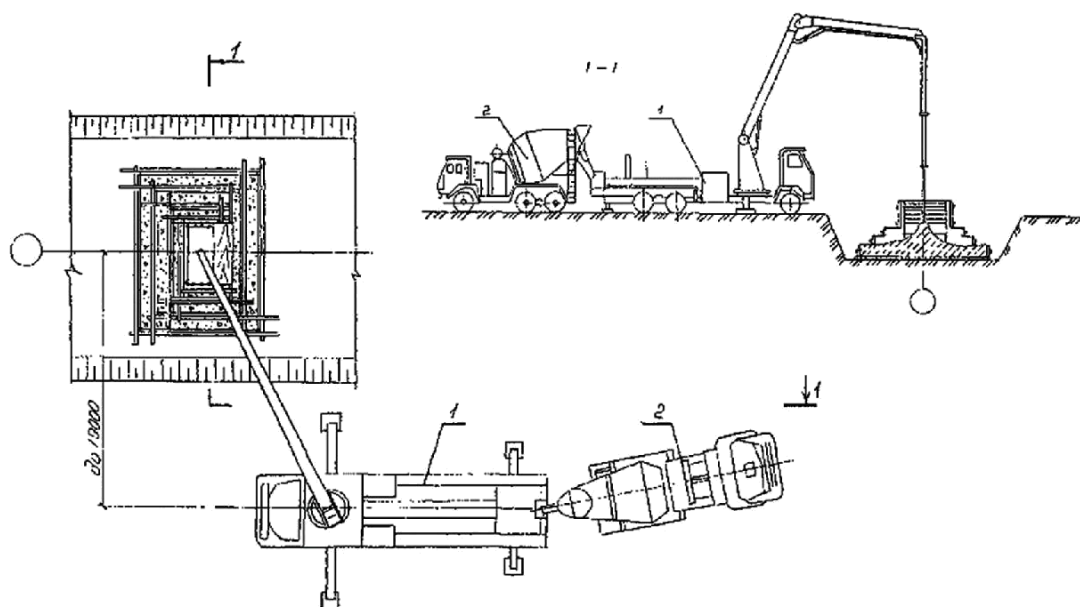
Схема производства бетонных работ при подаче бетонной смеси автобетононасосом:
